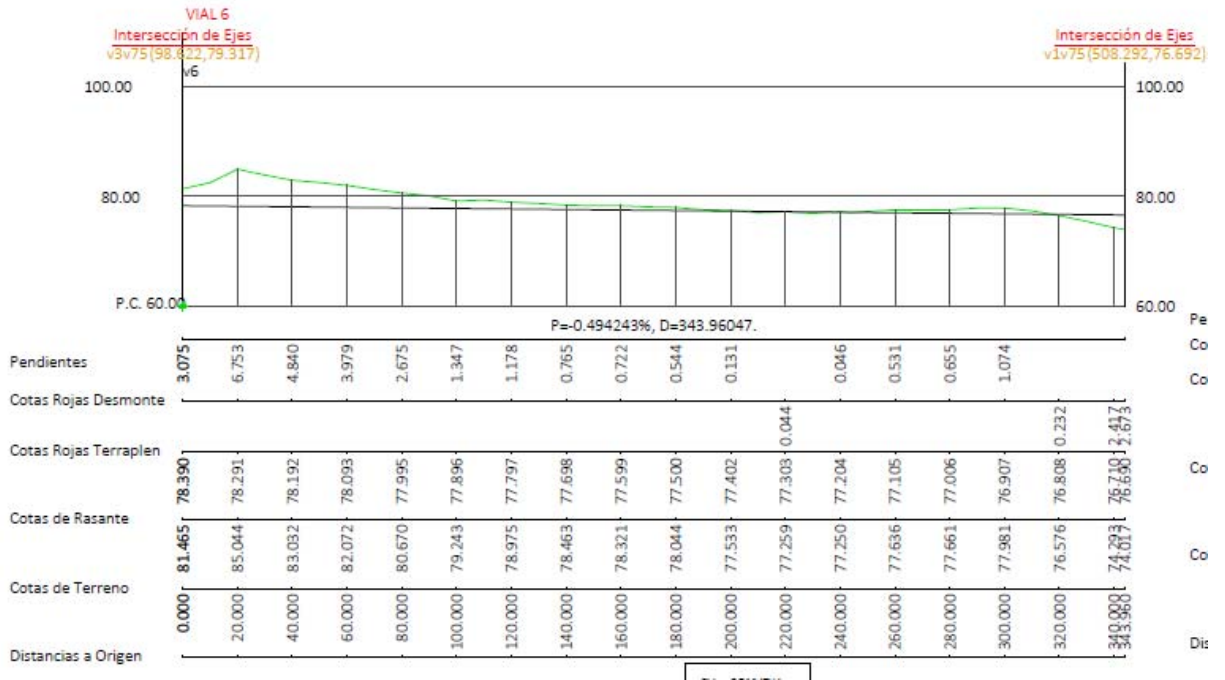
Imagen de la sección longitudinal del vial 6 en la alternativa 1.
